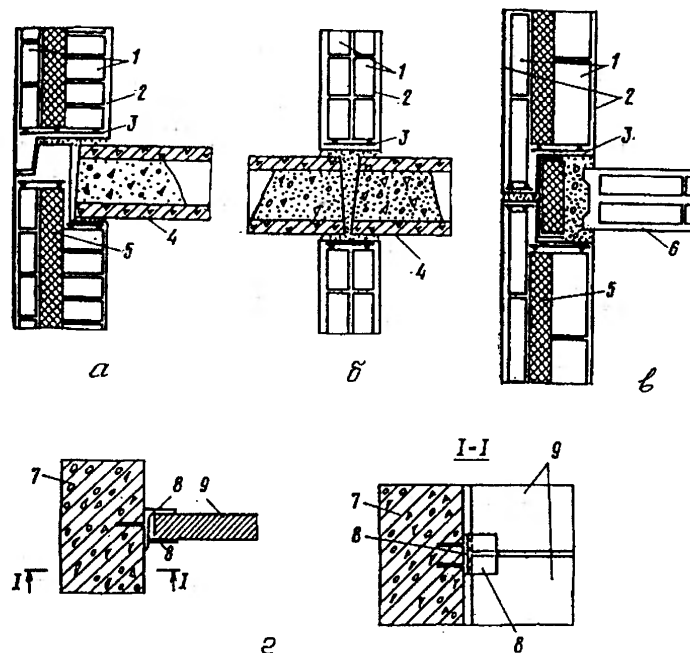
Узлы сопряжения конструктивных элементов: а – горизонтальный стык наружной стеновой панели с плитой перекрытия; б – горизонтальный стык внутренней стеновой панели с плитой перекрытия; в – вертикальный стык наружных и внутренних стеновых панелей; г – крепление виброкирпичной перегородки к железобетонной колонне; 1 – кирпич; 2 – растворный шов; 3 – арматурный каркас; 4 – железобетонная плита; 5 – плитный утеплитель; 6 – внутренняя стеновая панель; 7 – железобетонная колонна; 8 – монтажная деталь; 9 – виброкирпичная перегородка
